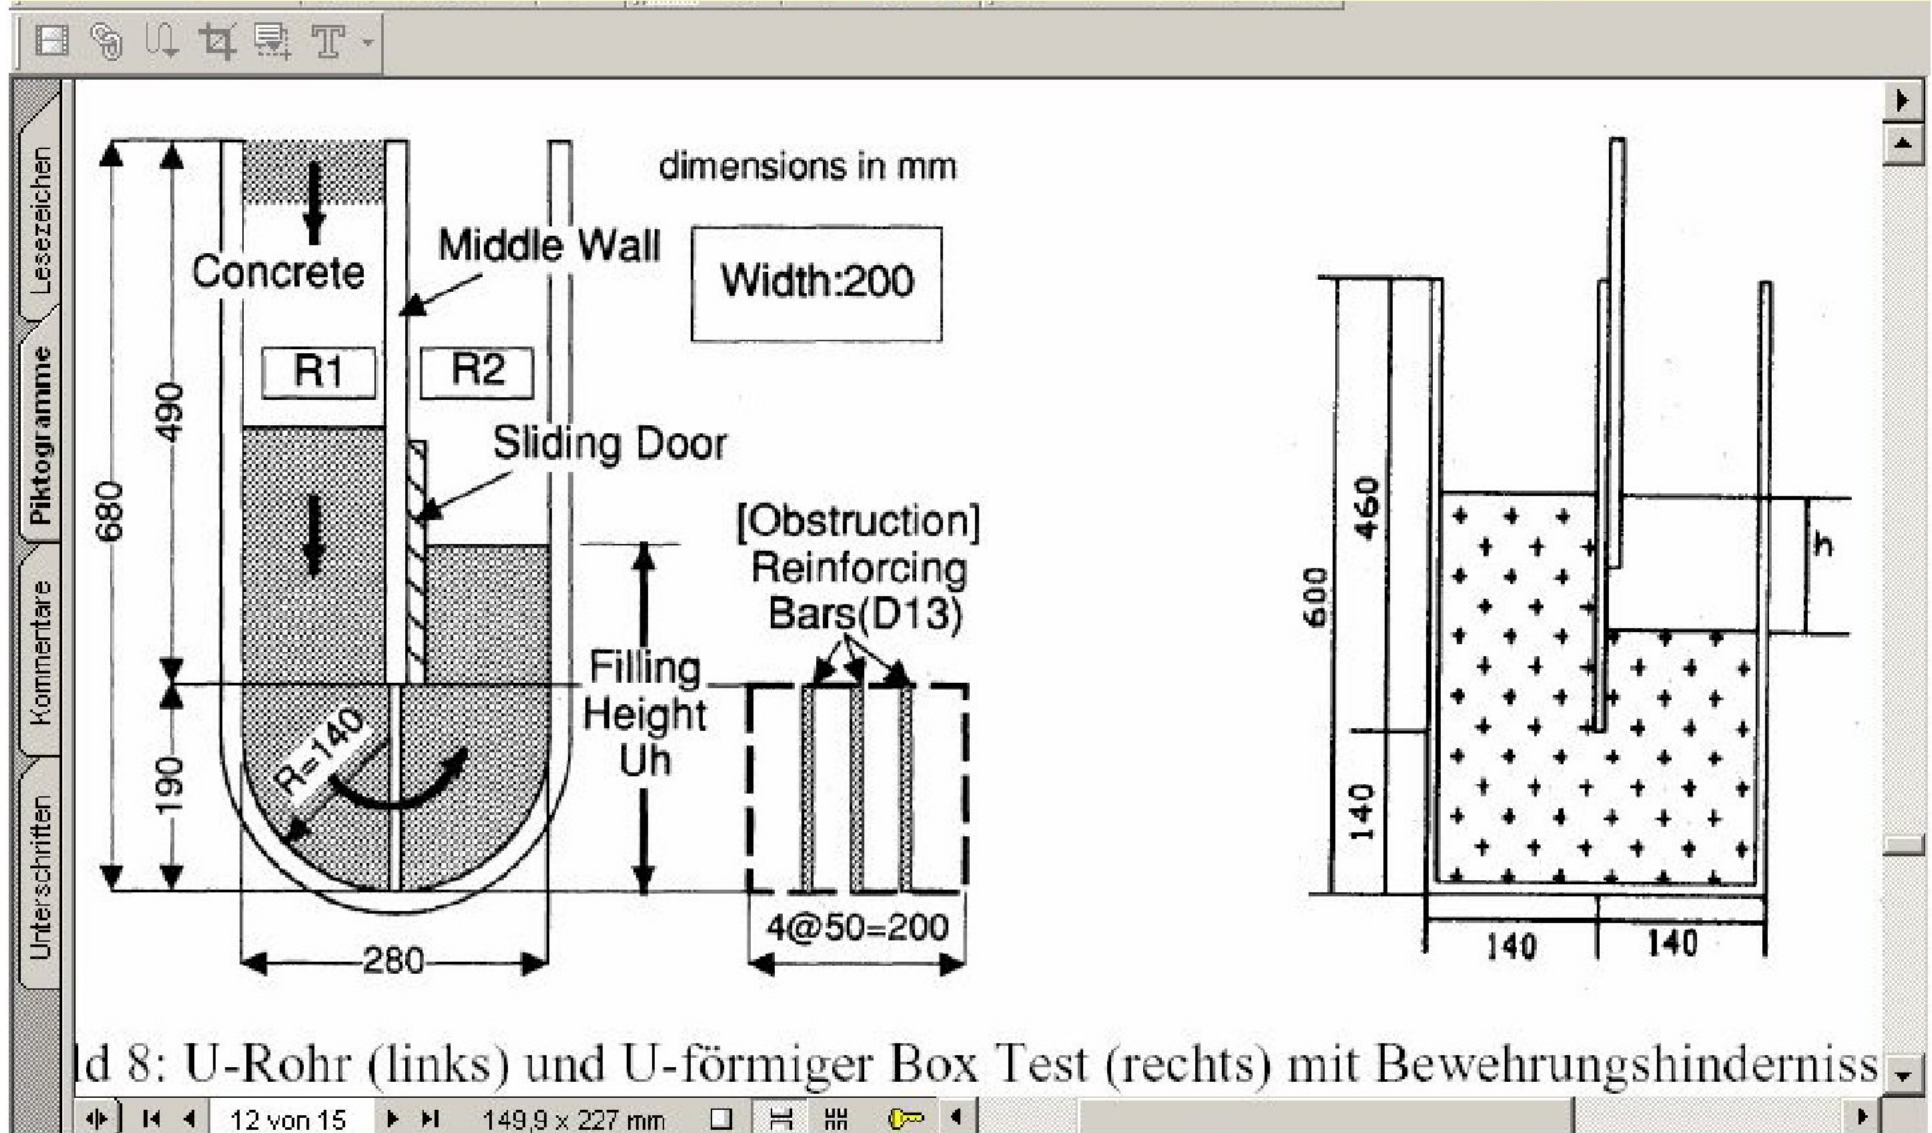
U-Rohr (links) und U-förmiger Box Test (rechts) mit Bewehrungshinderniss
